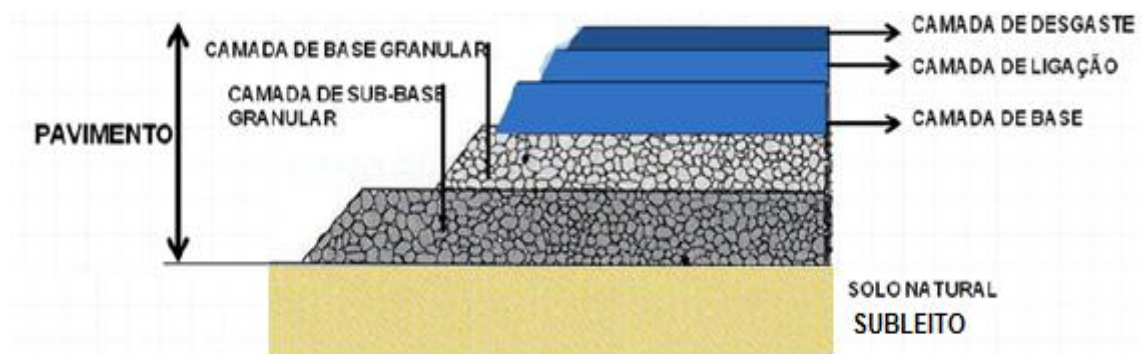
Diagrama esquemático da estrutura de um pavimento rodoviário.
